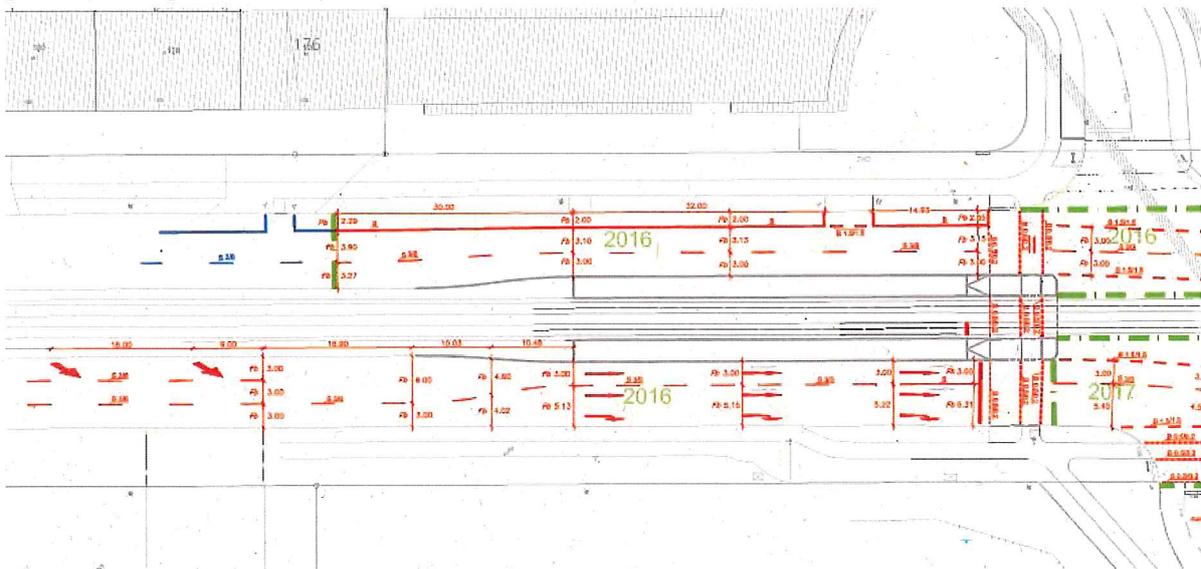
Auszug Markierungsplan Dachauer Str. (Stand 17.10.2016)
